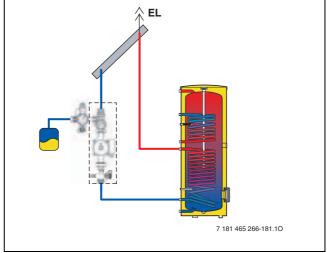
Anschluss-Schema mit 1-Strang-Solarstation und Entlüfter am Dach
